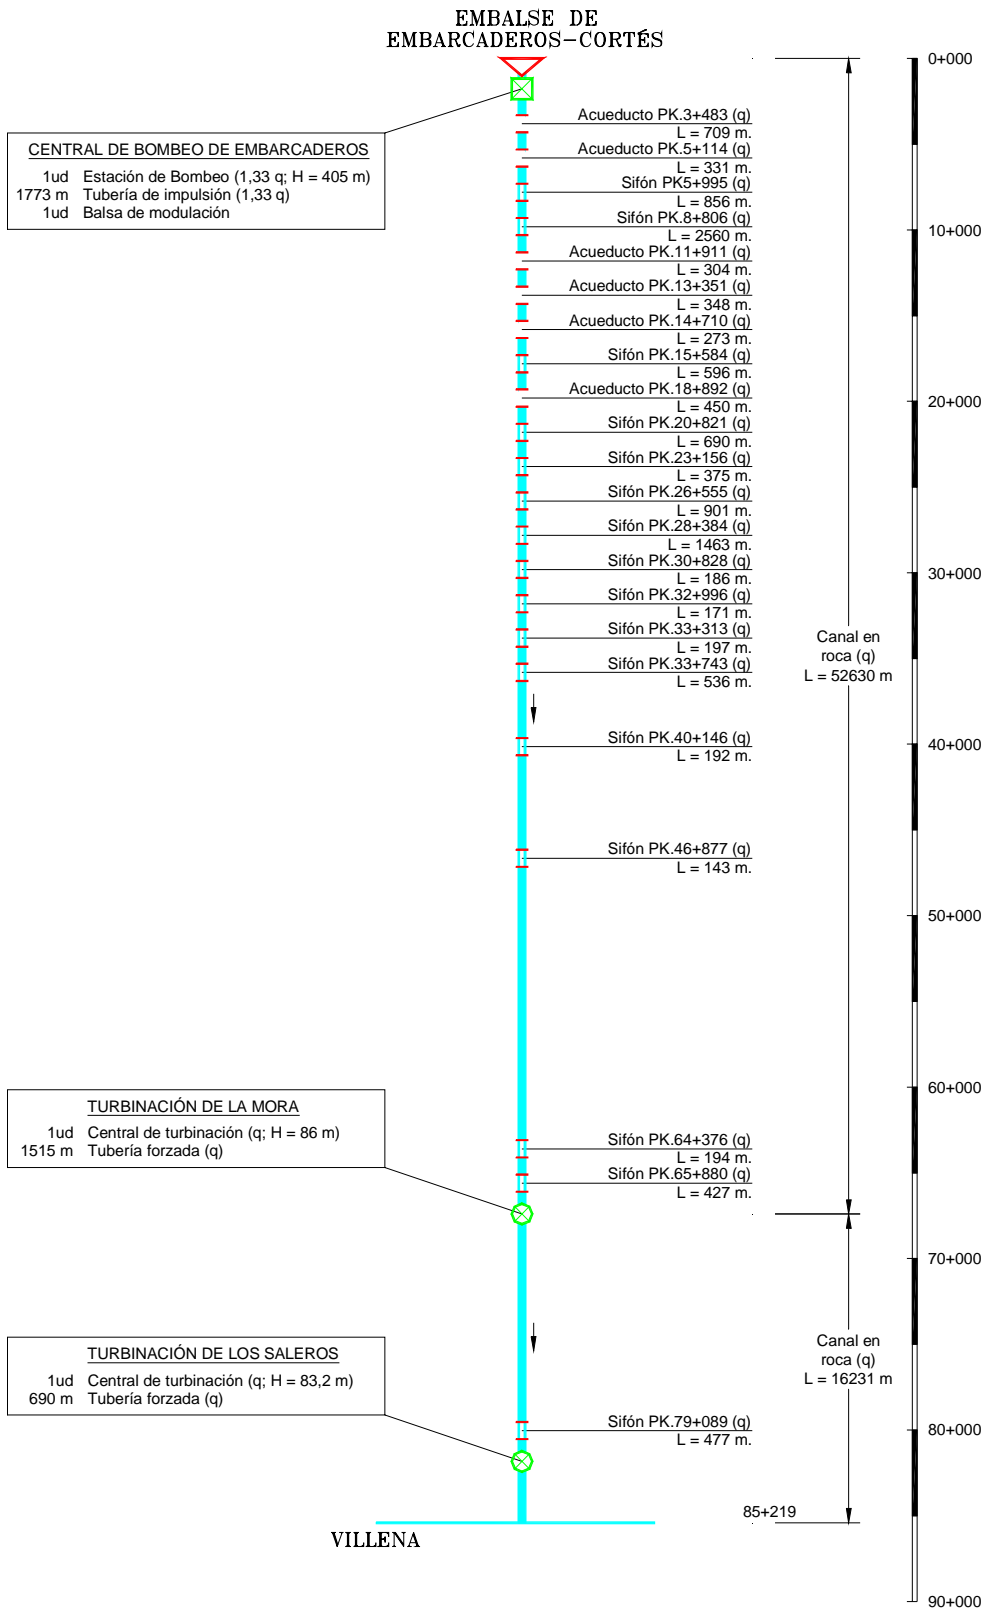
Conducción Embarcaderos - Villena. Esquema en planta
